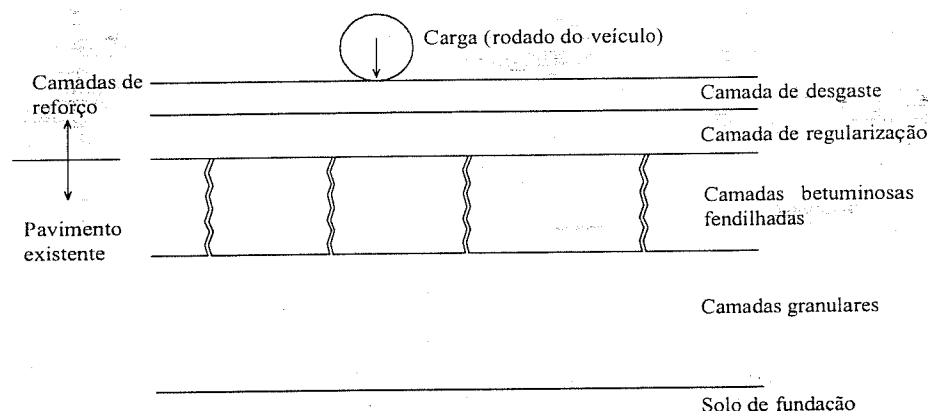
Representação esquemática da estrutura do pavimento após reforço
